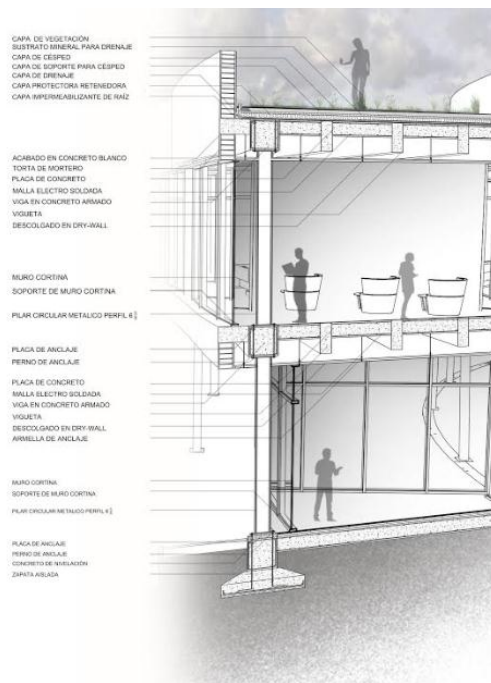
corte fachada del proyecto, fuente: elaboración propia.
